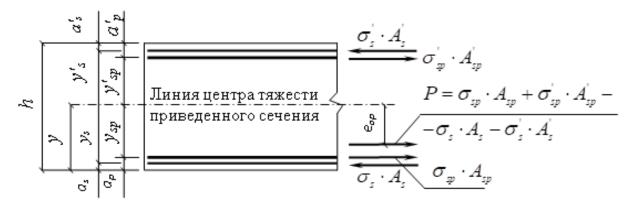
Схема усилий предварительного напряжения арматуры в поперечном сечении железобетонного элемента
